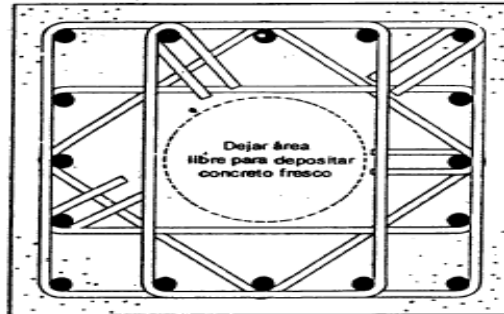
Acero de confinamiento en columnas sujetas a fuerzas sísmicas intensas [4]
